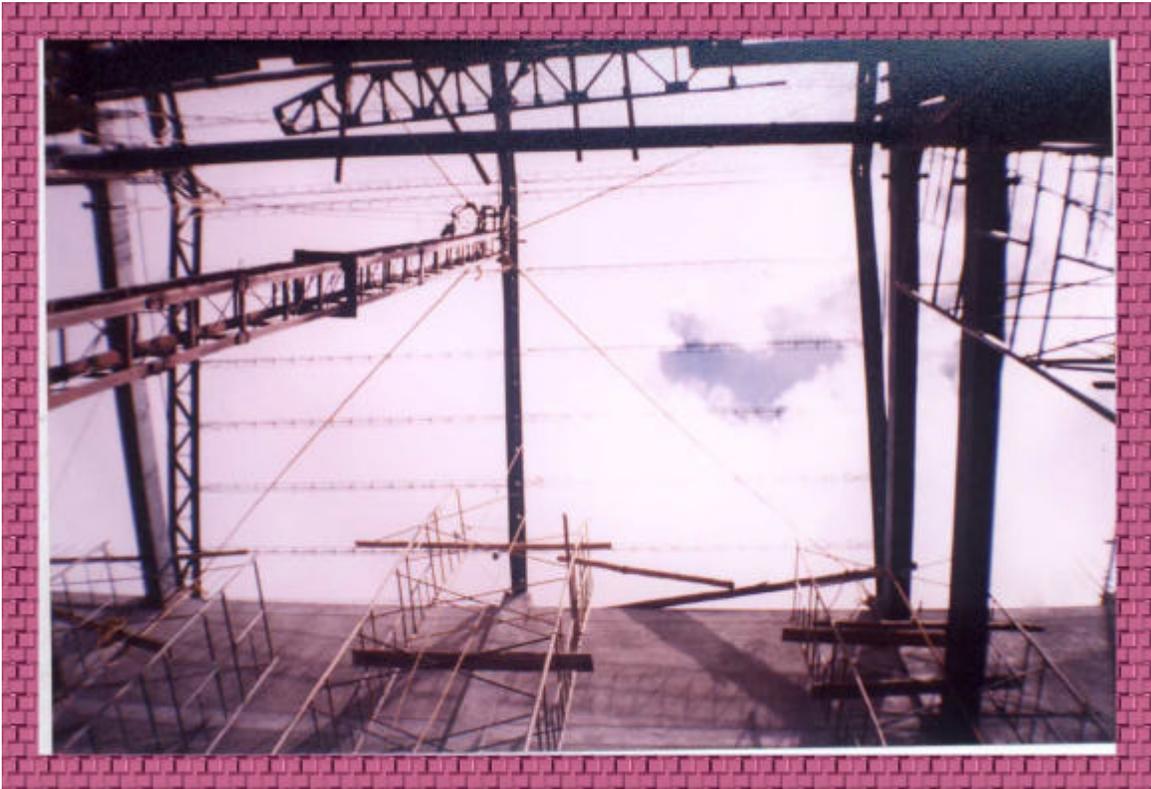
Montaje y soldadura de las últimas dos cerchas de la cubierta a dos aguas a los niveles 14.82m
